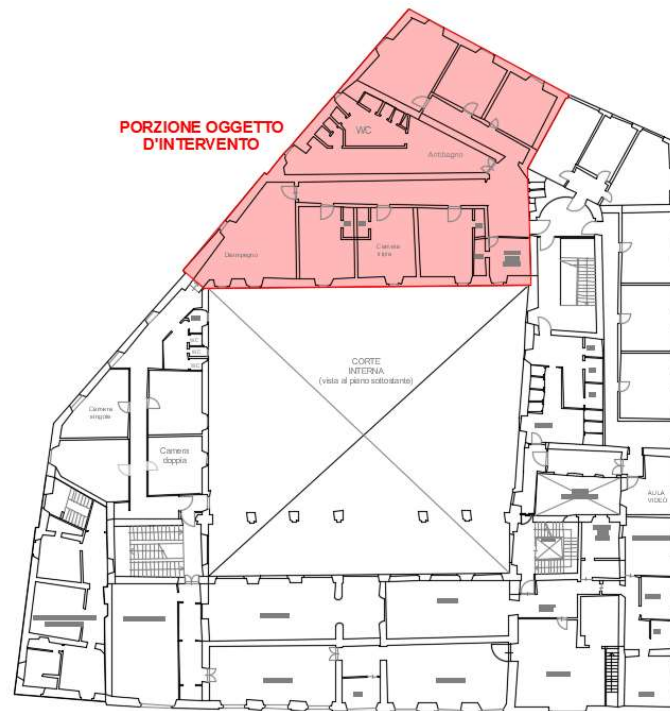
Individuazione della porzione del complesso oggetto d'intervento.
